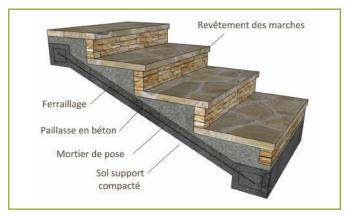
Schéma de principe d'une construction d'escalier sur paillasse (Dessin de Cédric Houel)
